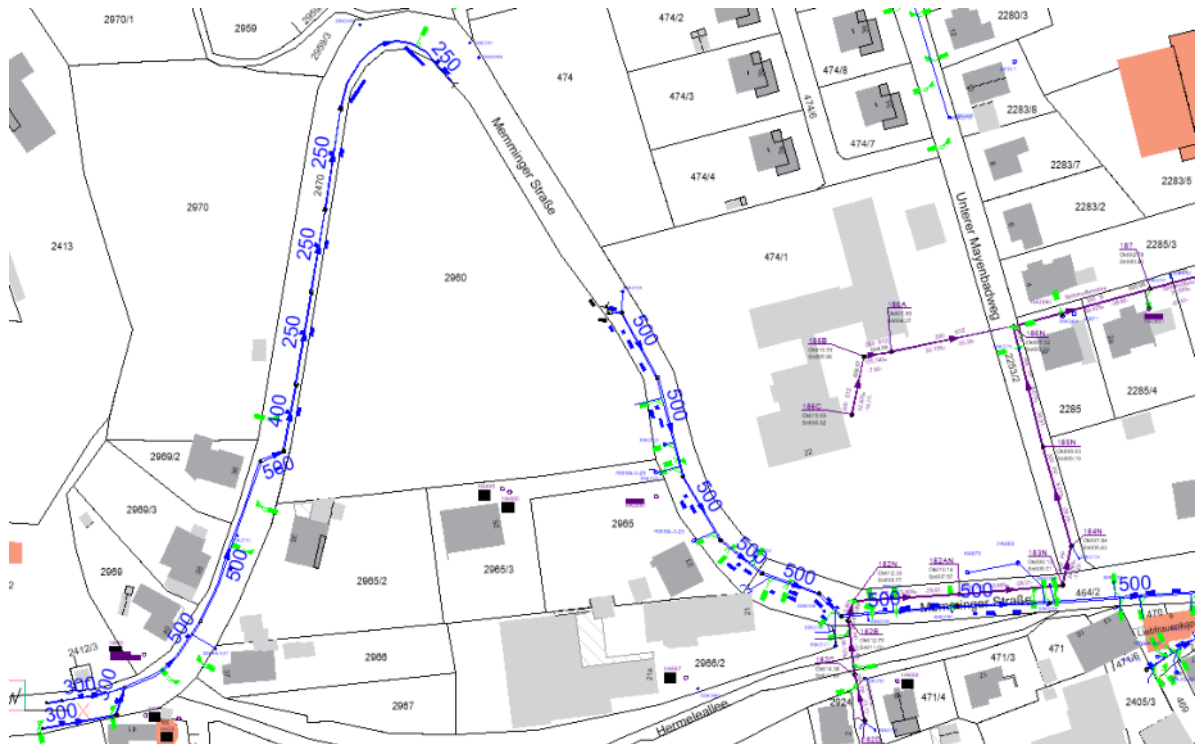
Regenwasserkanal Memminger Straße mit Dimensionen in mm
